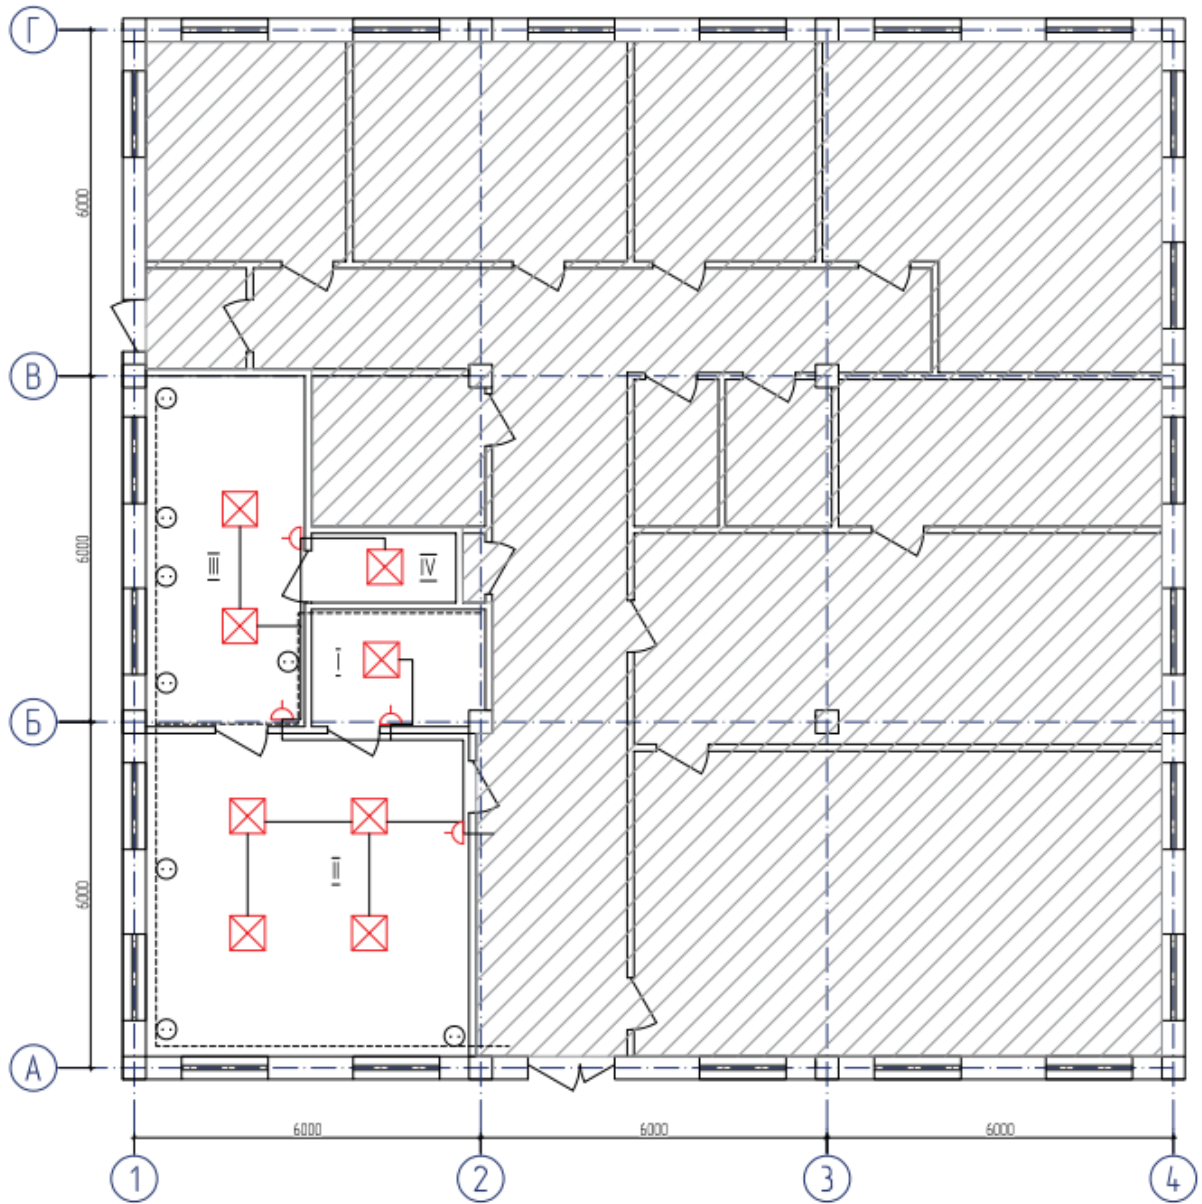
План підприємства, з урахуванням всієї будівлі, зі схемою електропостачання
